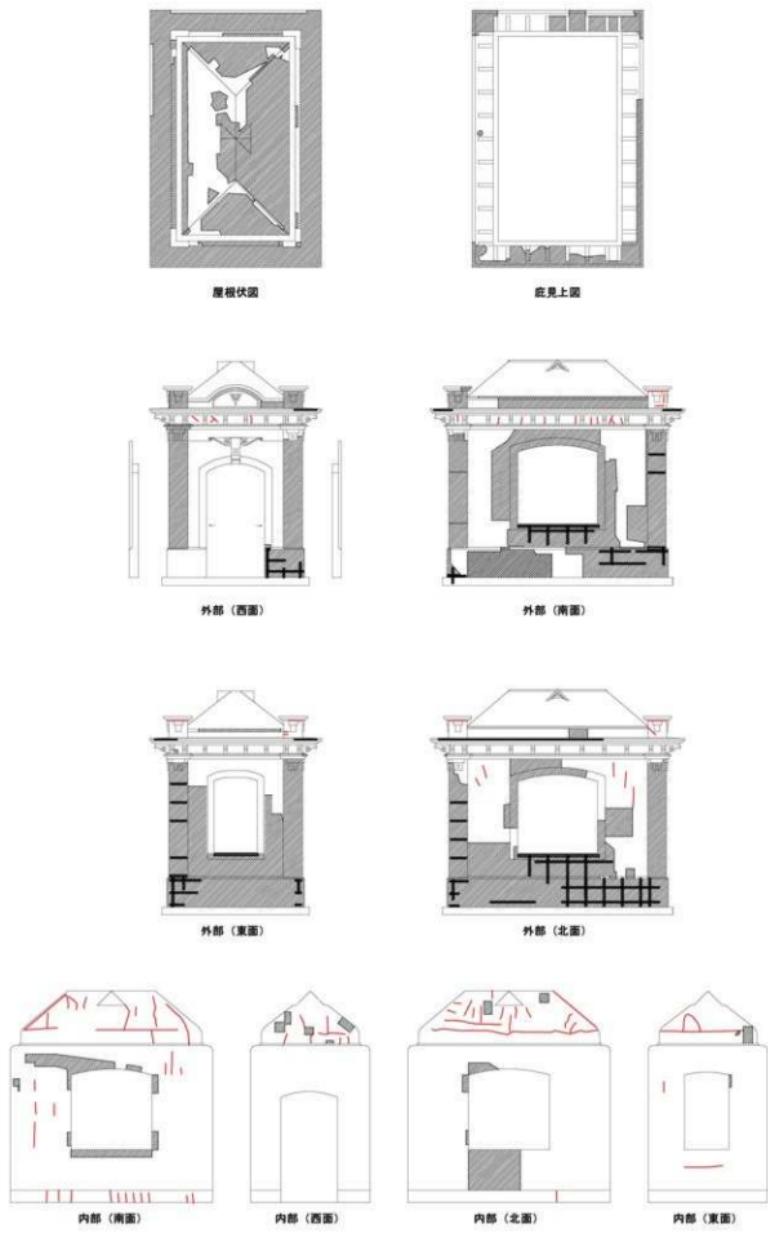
制水井4号上屋 補修図 ■ 断面修復 ── 鉄骨補足 ━━ ひび割れ注入 (幅0.2mm以上かつひび割れ内部がエプロレッセンスで詰まっていない箇所)
